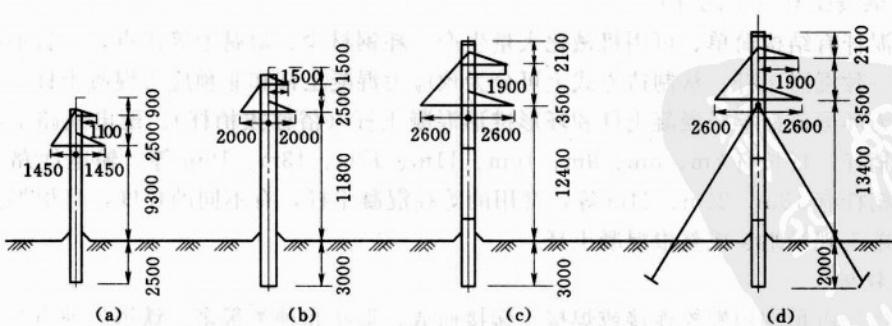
35~110kV 钢筋混凝土直线单杆 (单位: mm)
